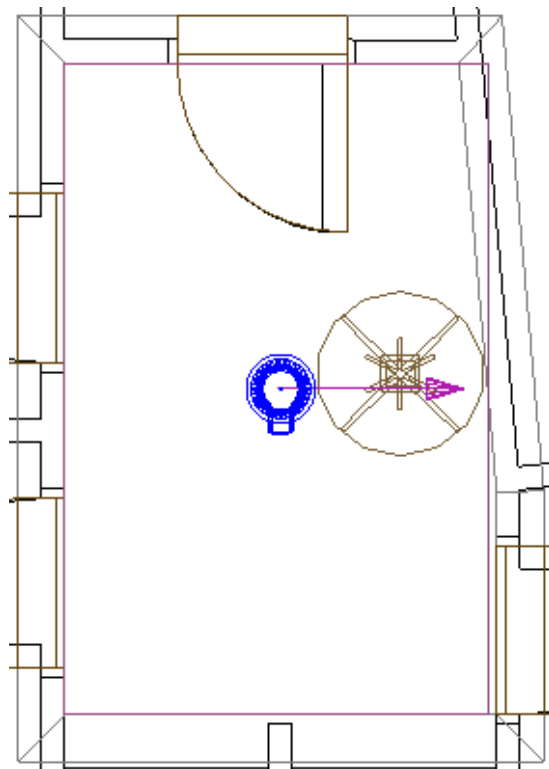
Plano del área de circulación de la primera planta de la vivienda unifamiliar.
